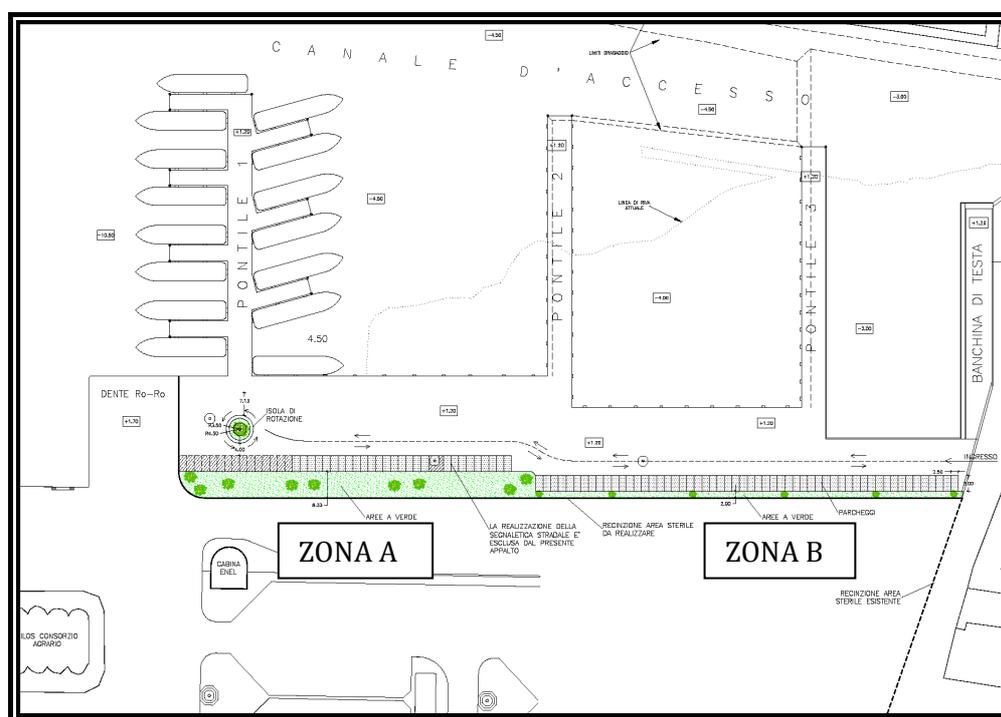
Planimetria di progetto con individuazione dell'Area Verde.
